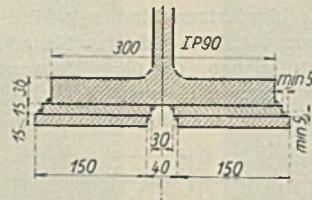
Brücke in Neuchâtel, Schweiz. Breitflanschträger IP 90 mit aufgeschweißten Gurtplatten.
